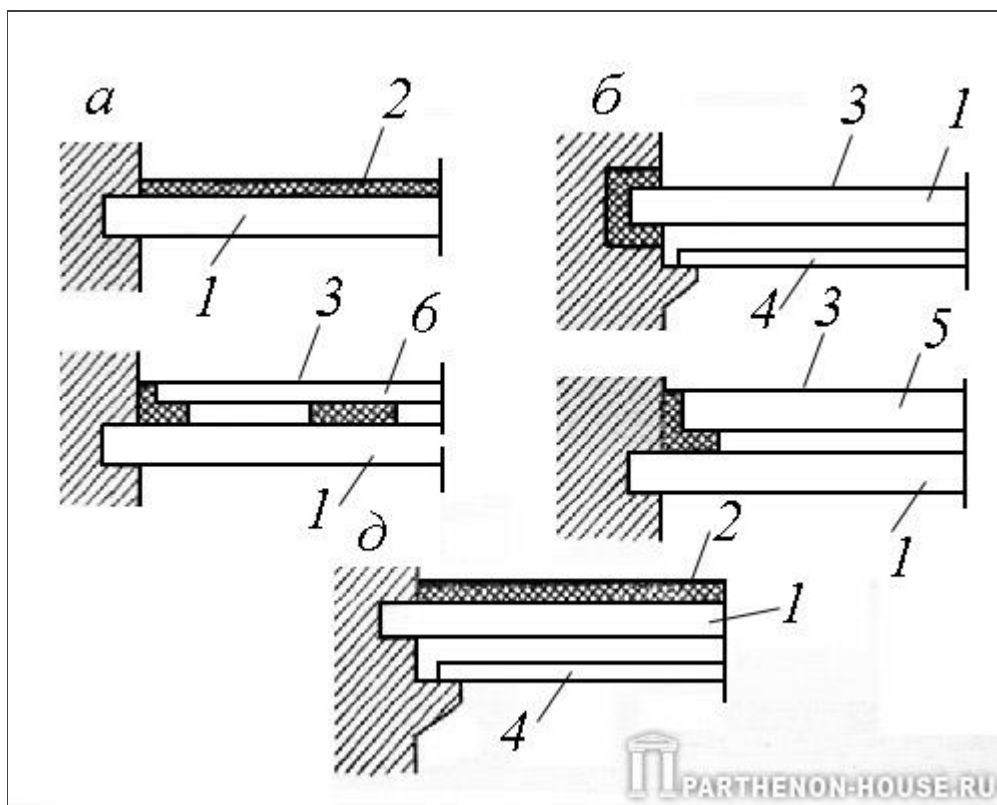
Конструктивные схемы железобетонных междуэтажных панельных перекрытий: а - со слоистым покрытием пола; б - с отдельным потолком; в - в отдельном полом; г - из двух несущих панелей; д - со слоистым покрытием пола и отдельным потолком; 1 - несущая панель перекрытия; 2 - звукоизолирующий слоистый пол; 3 - покрытие пола; 4 - панель отдельного потолка; 5 - несущая панель пола; 6 - панель отдельного пола
